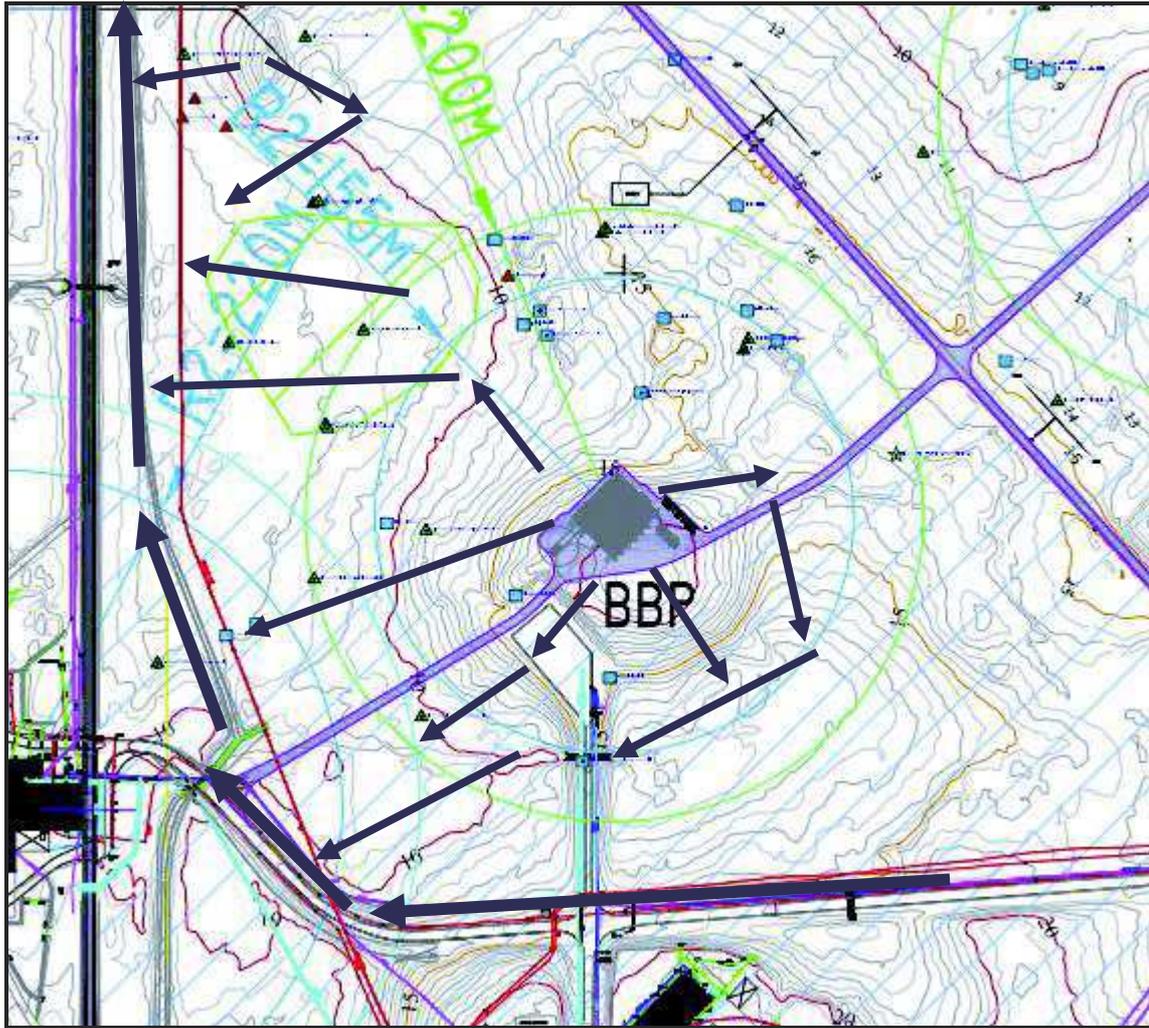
Plan d'écoulement des eaux pluviales au niveau de la zone d'implantation du bâtiment
